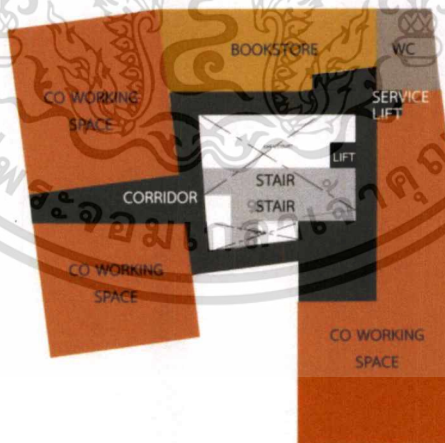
ZONING 1<sup>ST</sup> FLOOR
